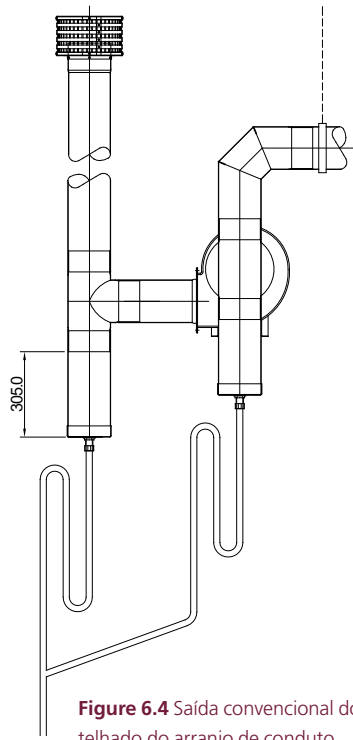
Saída convencional do telhado do arranjo de conduto
